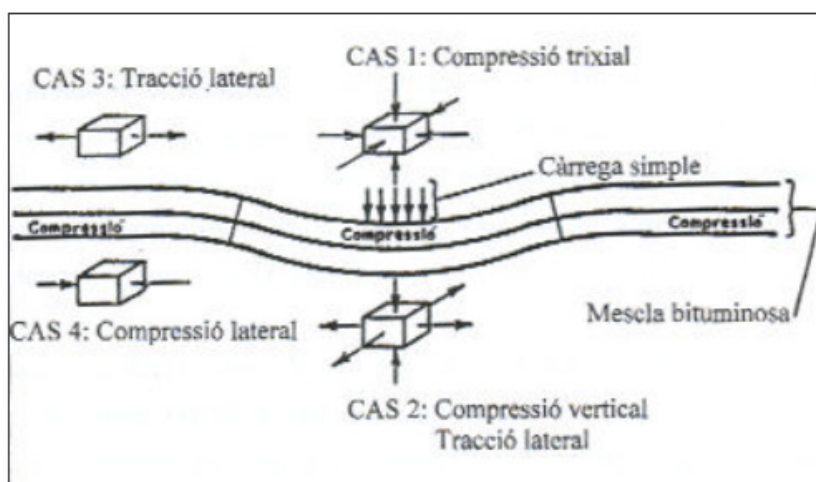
Estado de tensiones a la que está sometido un pavimento bajo la acción de una carga simple. Fuente: Roque y Buttlar
